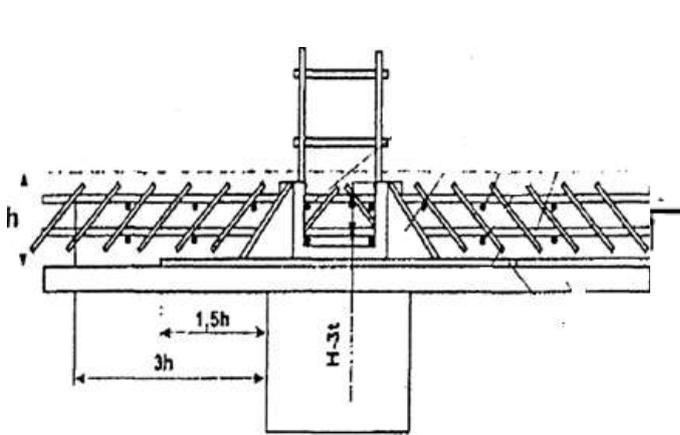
Конструкция безбалочного перекрытия в сборе с колонной, с установленной наклонной поперечной арматурой [1]
